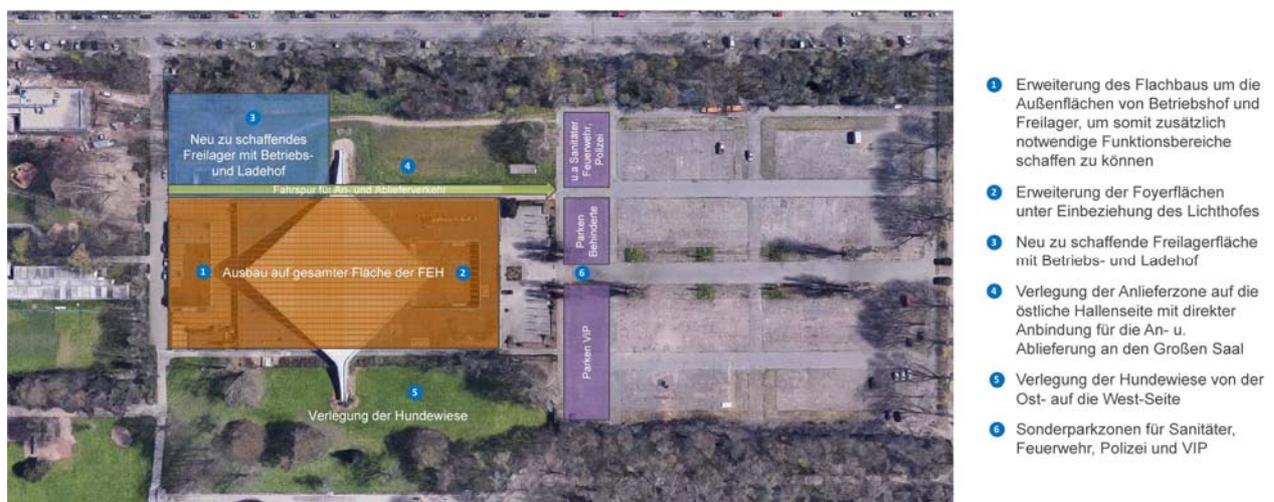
Szenario 3B - FEH im Grundbestand mit Erweiterungsfläche
